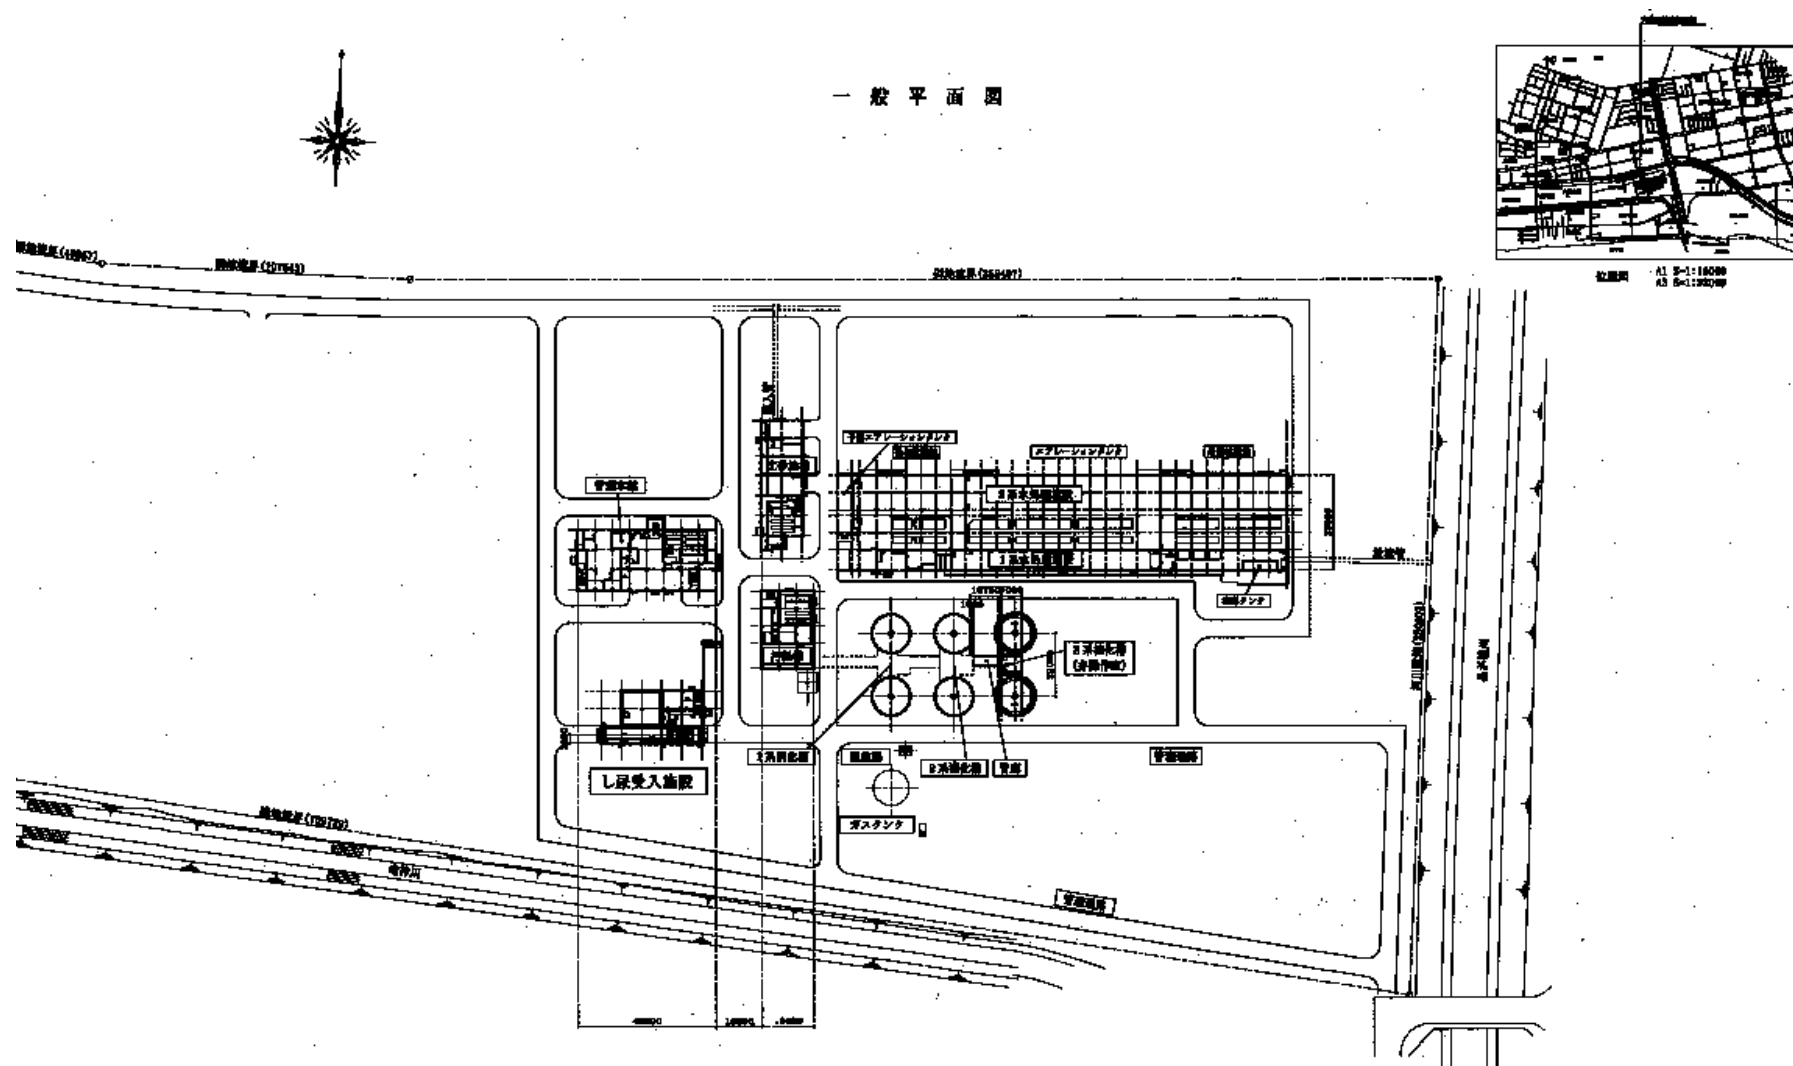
大楽毛下水終末処理場一般平面図(現況)
